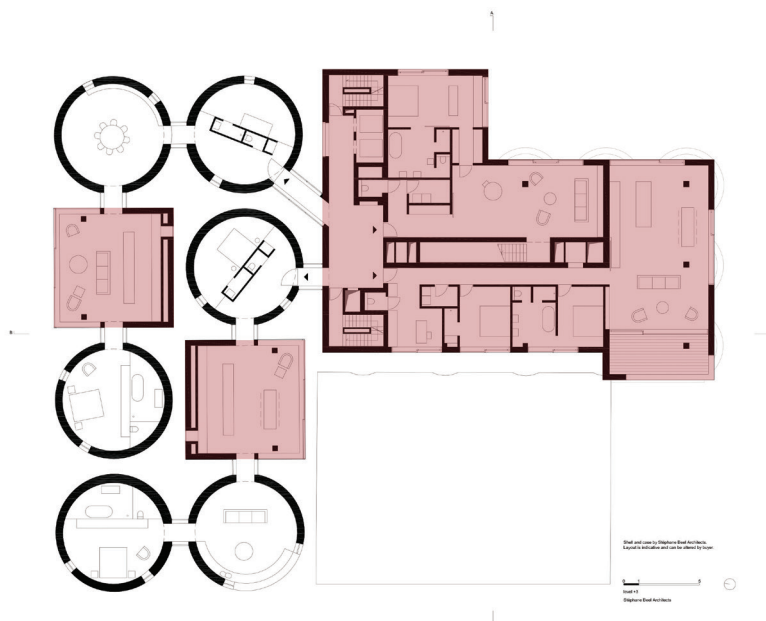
Plan schématique R+3 1/500 - Nouvelles constructions
